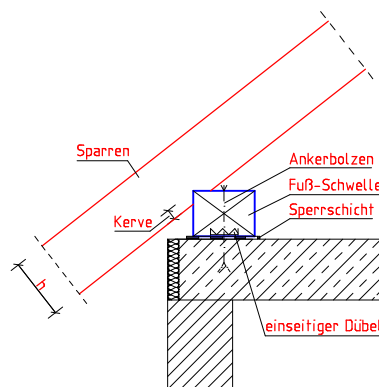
Fußschwelle ohne Dremel mit Dübel besonderer Bauart
